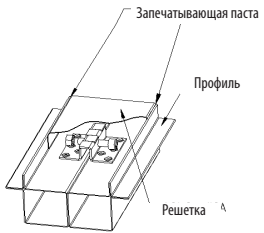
Маскирующий швеллер место соединения блоков установки
